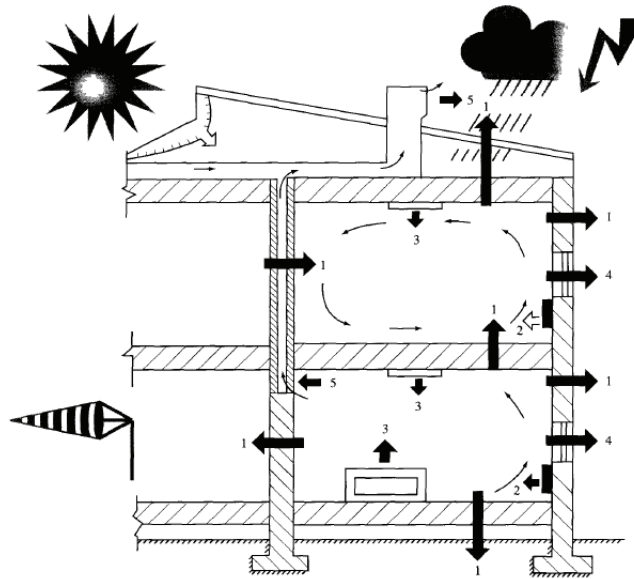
Схема теплового баланса здания: 1-теплопотери или теплопоступления через ограждающие конструкции (стены, покрытия, перекрытия и т. д.); 2-тепловыделения от отопительных приборов; 3-теплопоступления от технологического оборудования; 4-теплопотери или теплопоступления через заполнение светового проема; 5-теплопотери за счет воздухообмена
